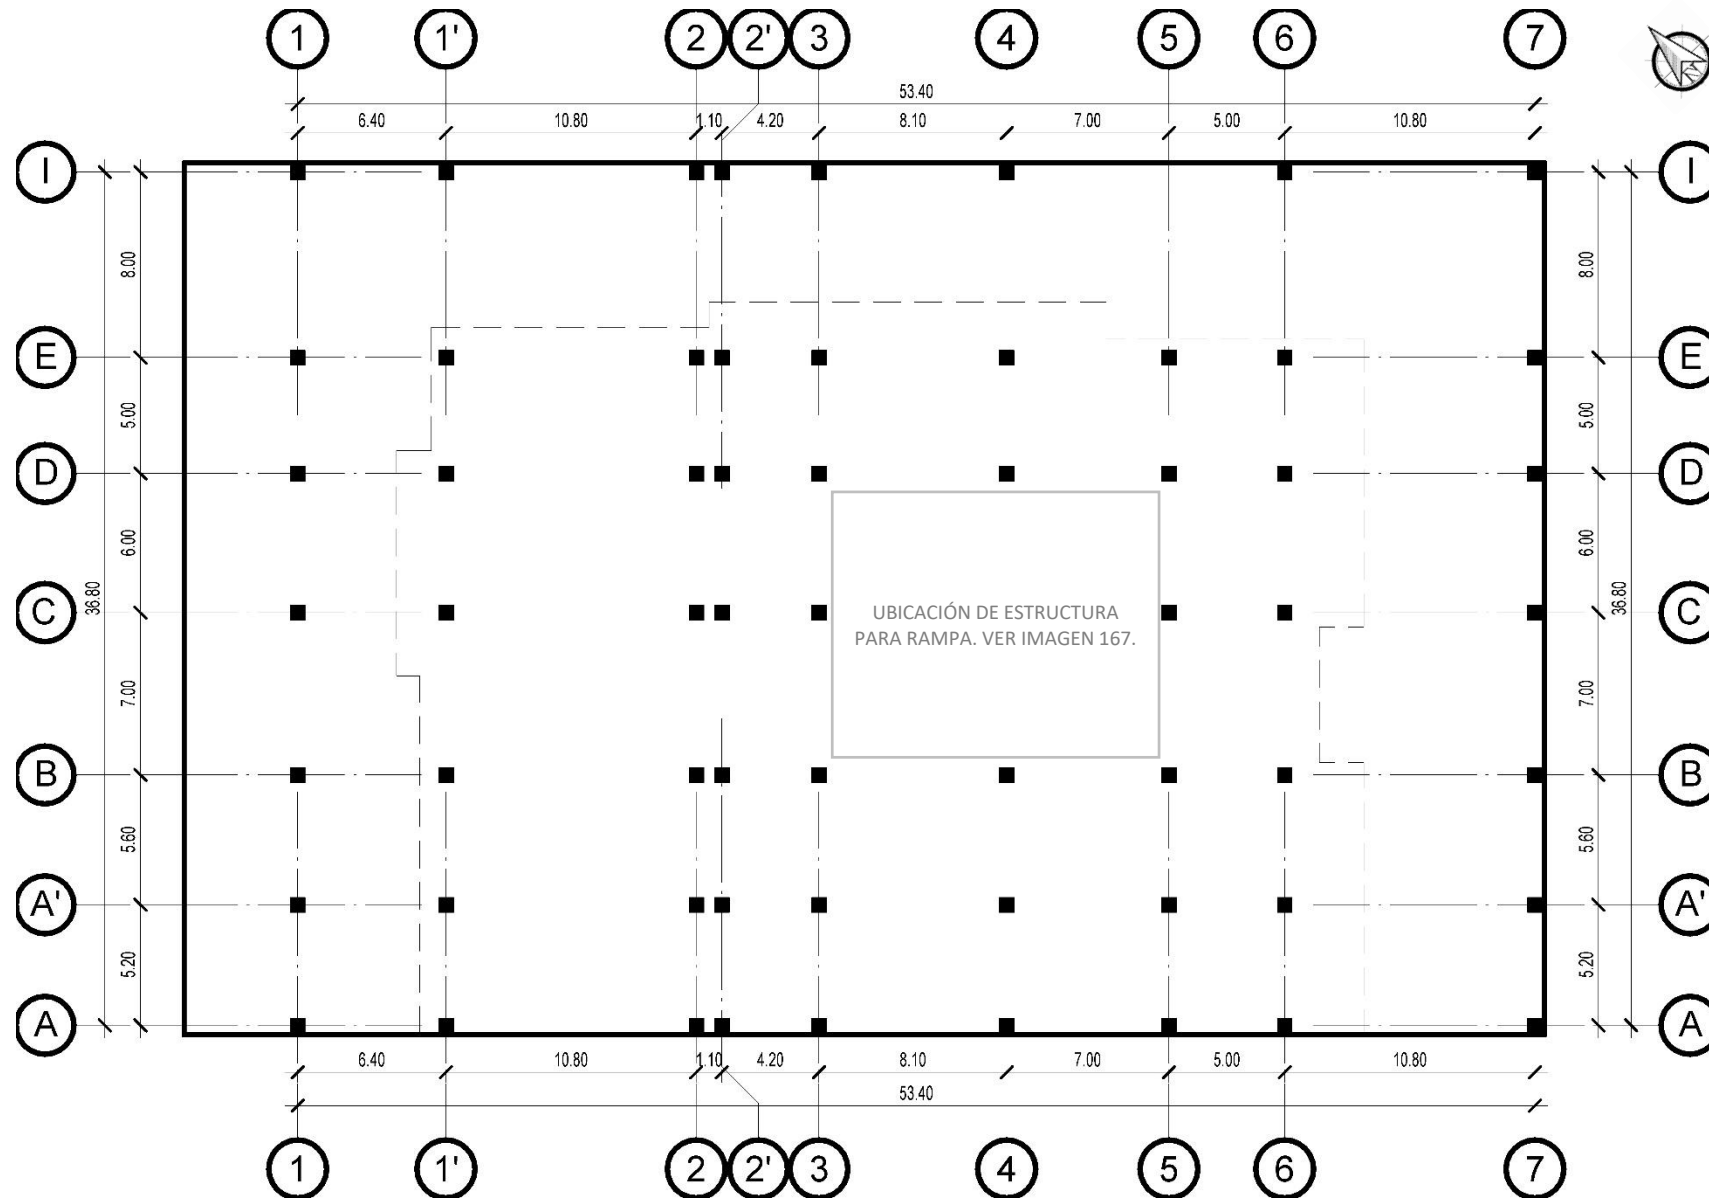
Planta Estructural. Fuente: Elaboración propia.
